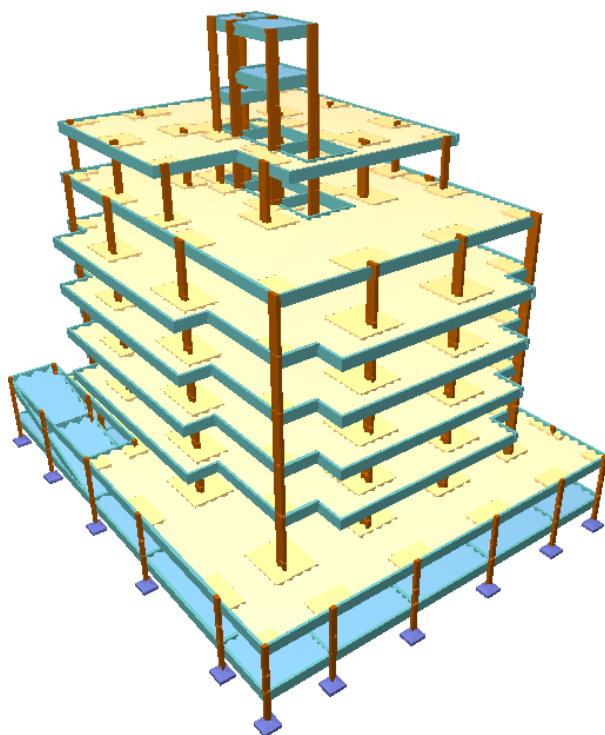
Estrutura 3D do edifício analisado no Estudo de Caso 1, considerando sistema estrutural de lajes nervuradas lisas com utilização de vigas de borda.
